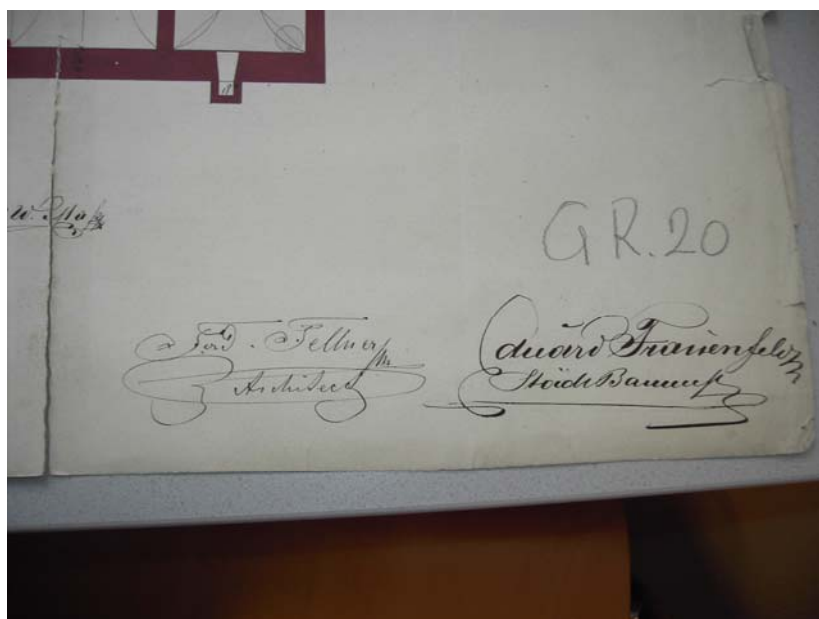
Einreich- / Ergänzungsplan zum Haus Liebieg, 14. 3. 1859, Detail: Signaturen.
